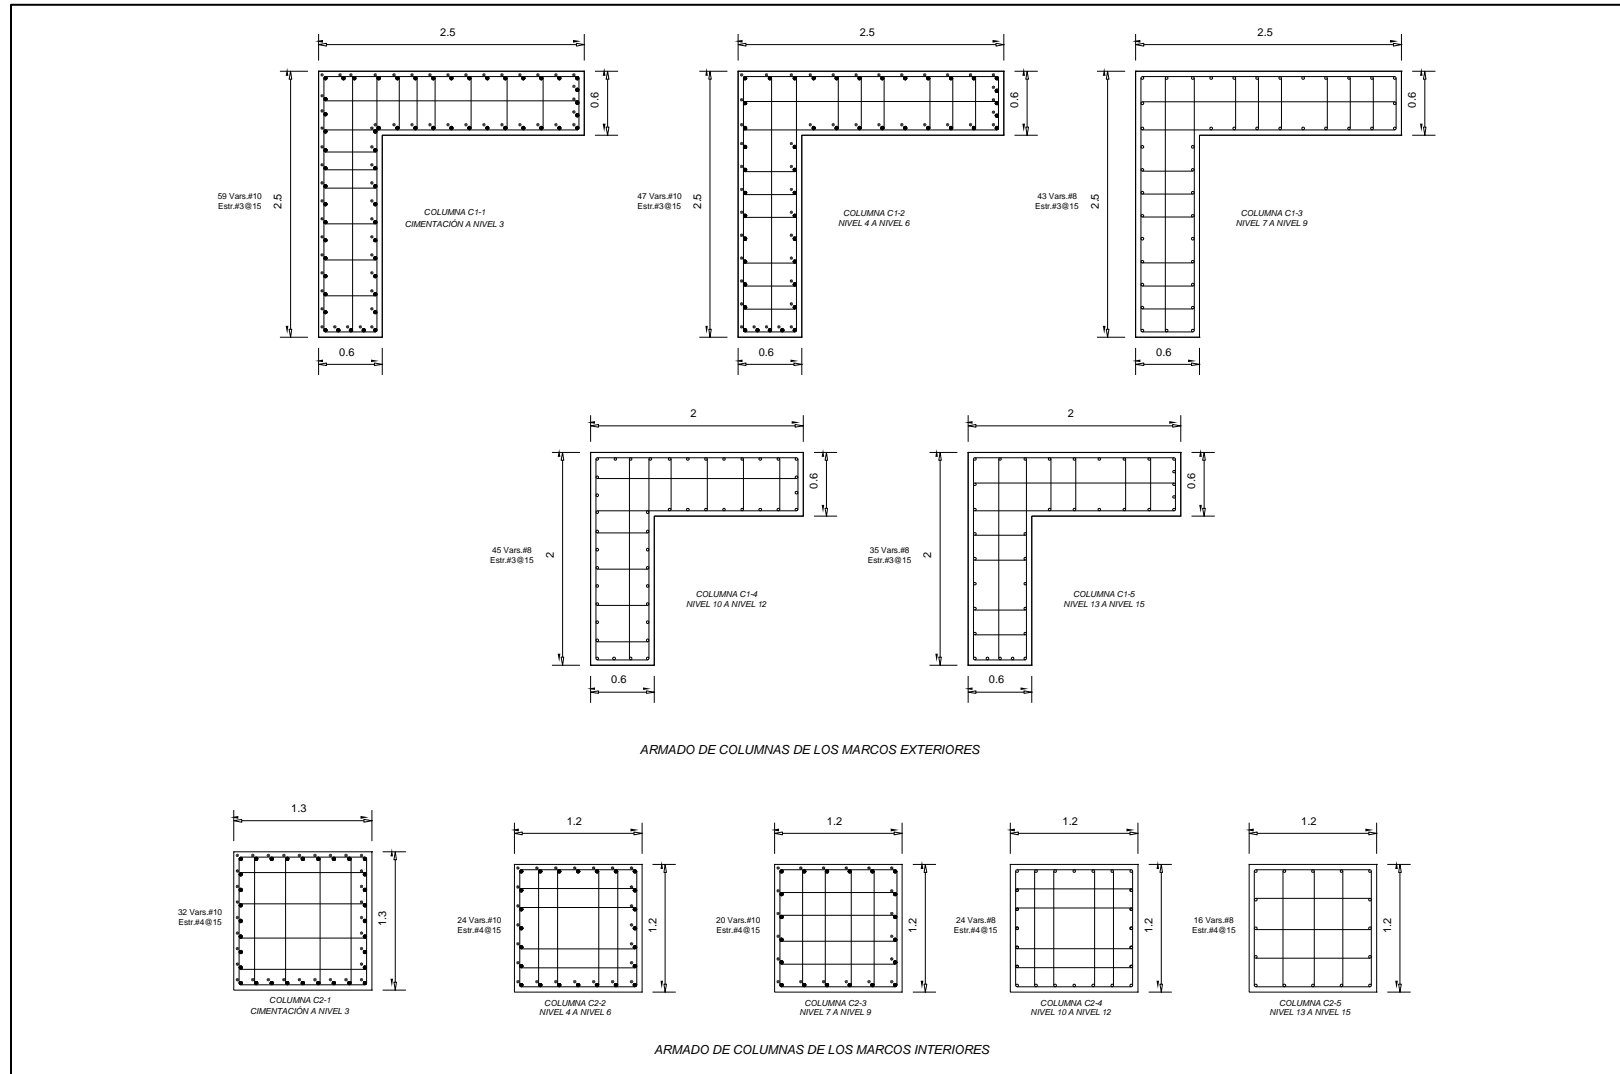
Detalles estructurales del edificio de 15 niveles diseñado con el ACI318-08
